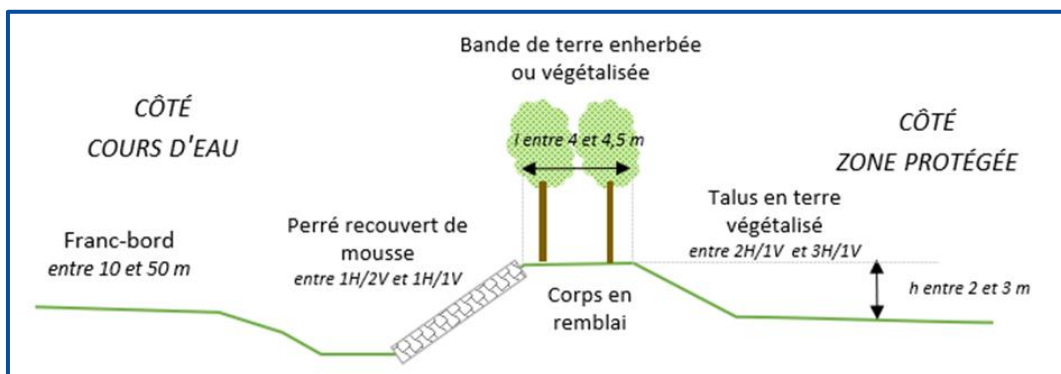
Coupe type du système d'endiguement de Lamothe – Tronçon 1 / Section b (T1b)
